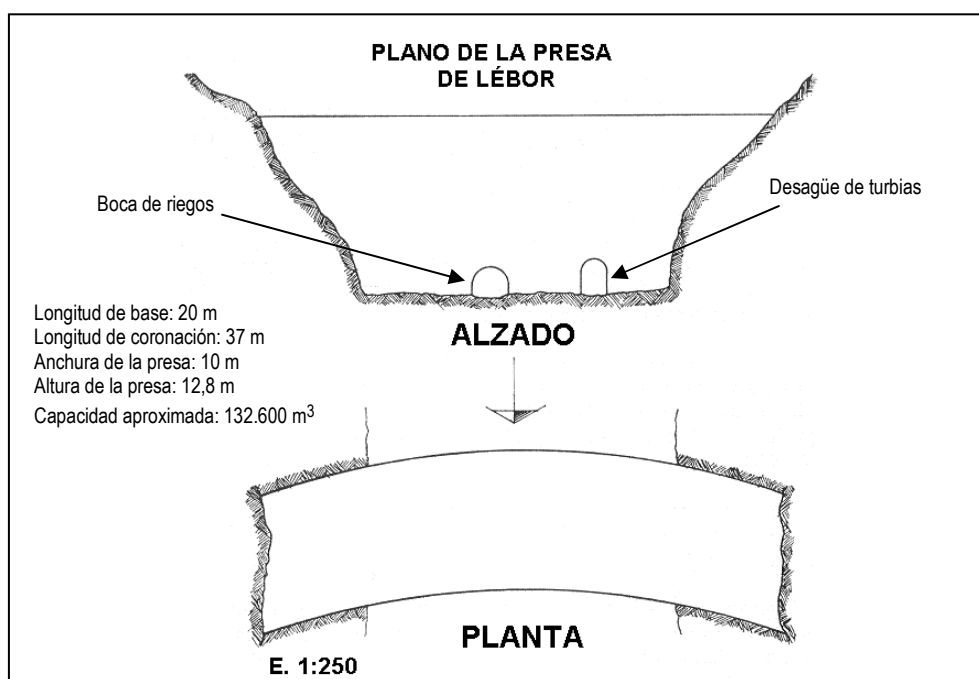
Representación de la presa de Lébor, alzado y planta (Méndez García, 1974)
